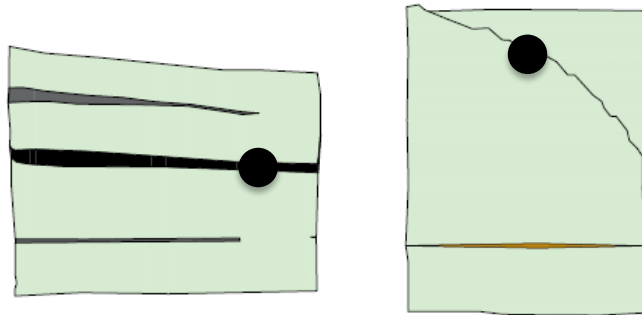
Fallas en el bambú “Corte paralelo a la fibra”.
